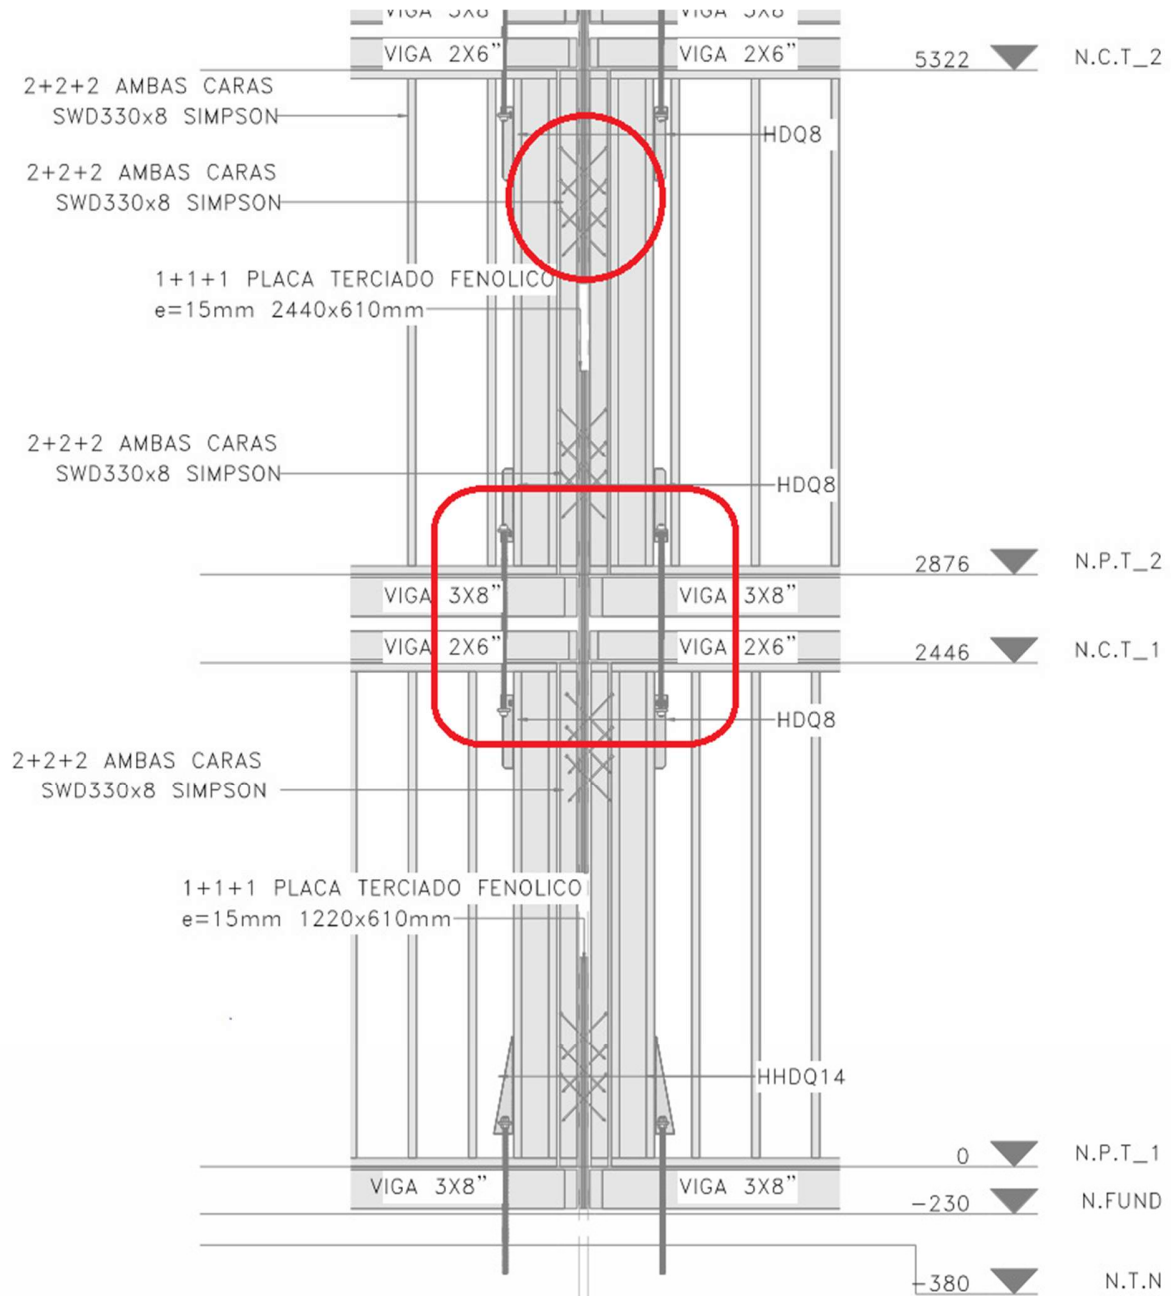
Detalle Elevación disposición fijaciones laterales y verticales. Fuente: Simpson Strong-Tie
